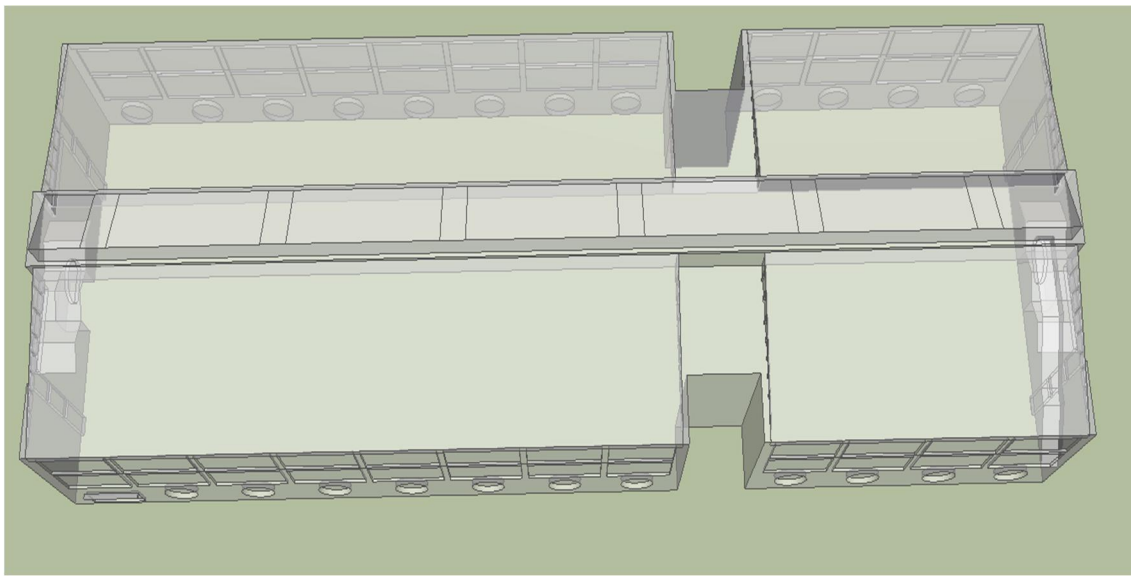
Se observan las dos zonas del edificio. La anterior es algo más larga que la posterior. Esta además dispone de unas escaleras externas para acceder al primer piso.
